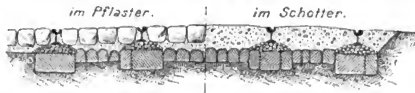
Unterbau der Straßenbahngleise in Holzpflaster. M. 1 : 50.
